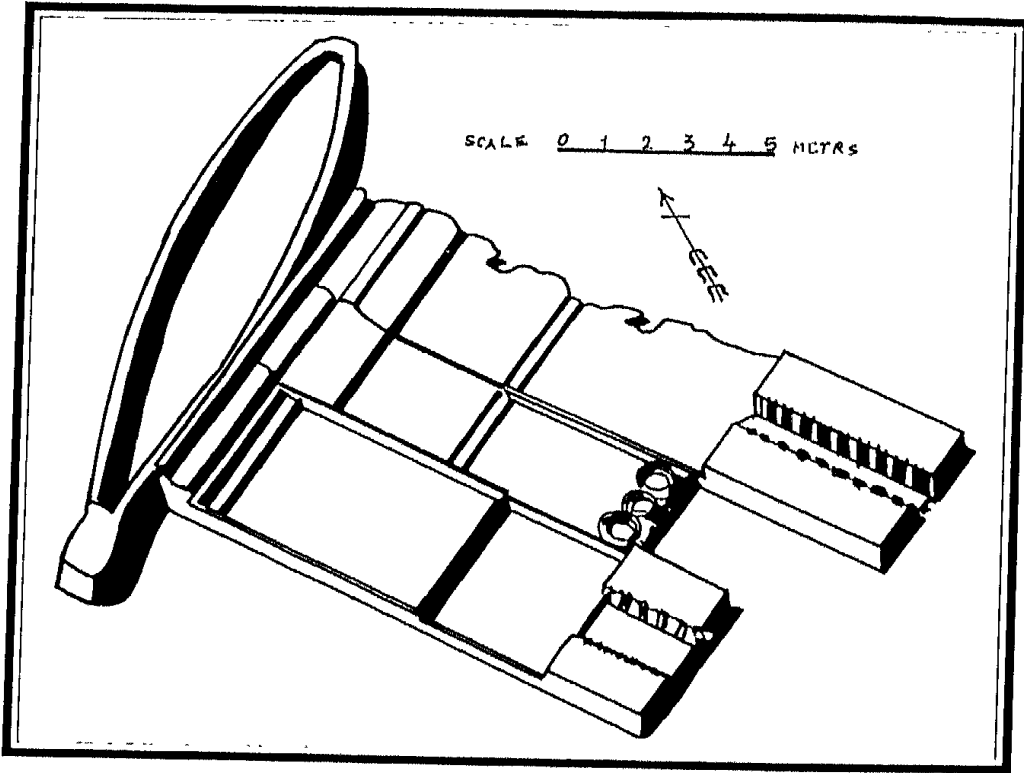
مسقط أفقى للمقبرة ٣٣٥٨ فى سقارة.
